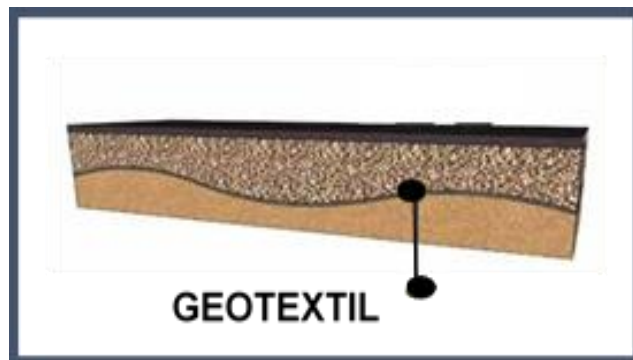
<http://www.pavco.com.pe/> geotextiles
